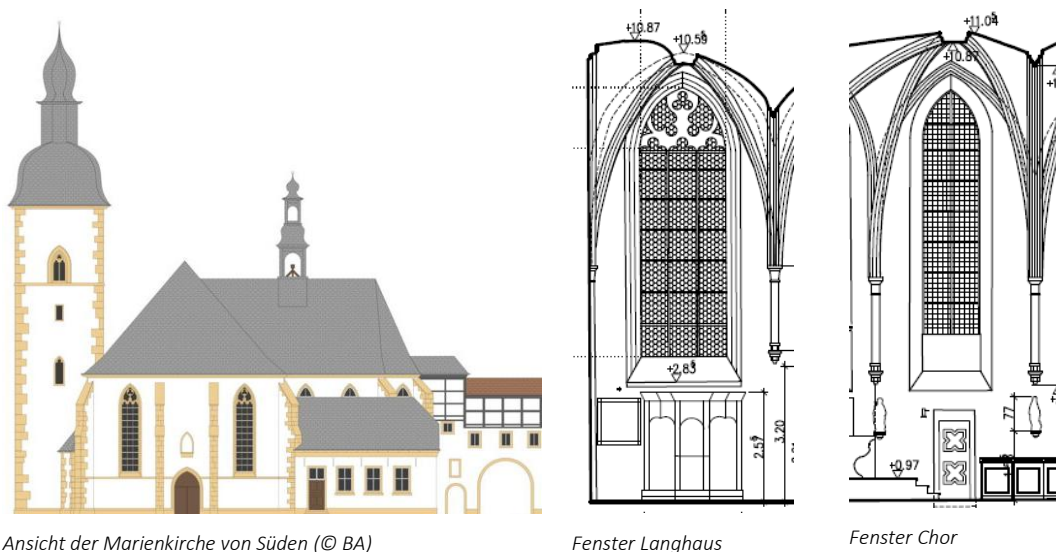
Dem Platz zugewandte Südfassade der Marienkirche und Fensterdetails
